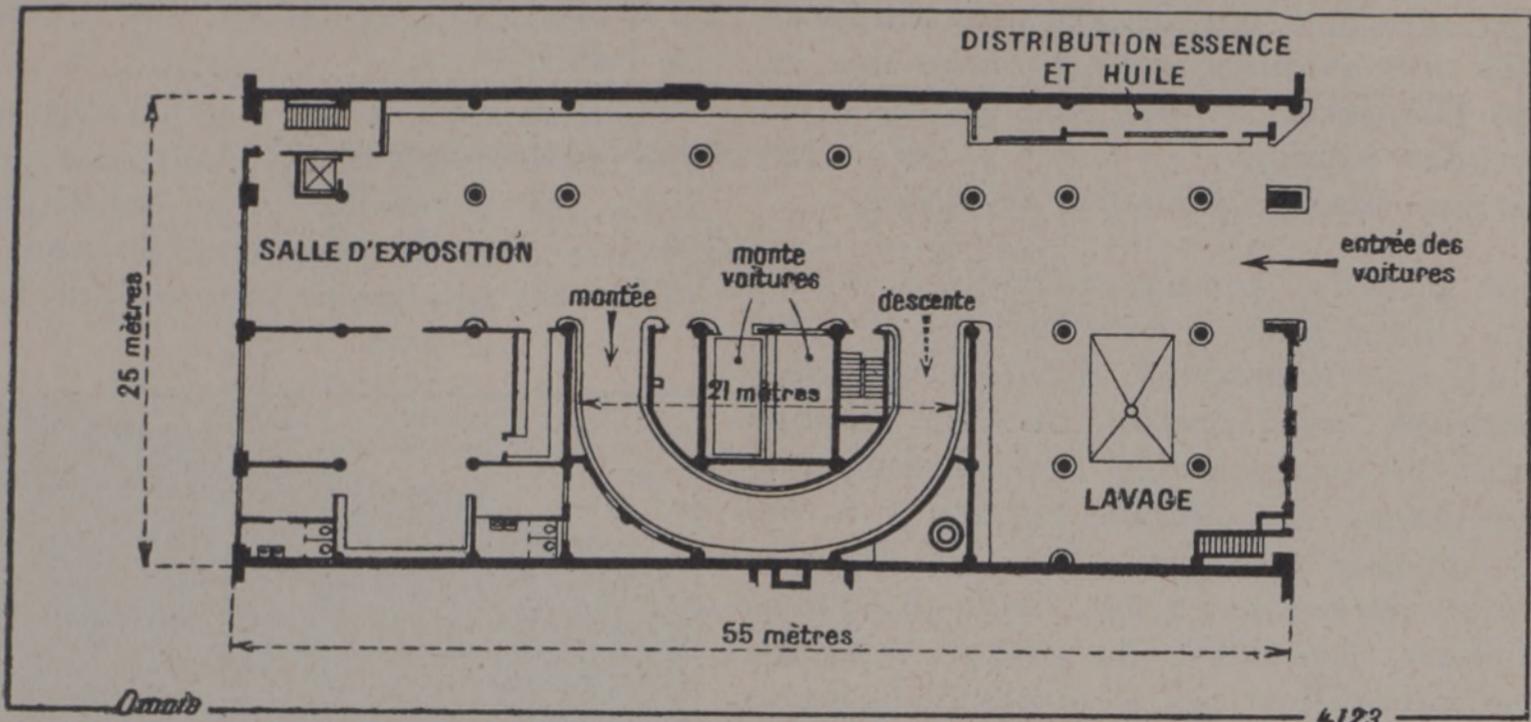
Fig. VI. — Plan d'un garage américain à rampe et à ascenseurs (Garage La Salle, à Chicago). Plan du rez-de-chaussée. Les voitures peuvent monter aux étages supérieurs soit par les ascenseurs, soit par la rampe. Les escaliers débouchent directement à l'extérieur. — A noter l'emplacement des postes de lavage et de distribution d'essence et d'huile.
